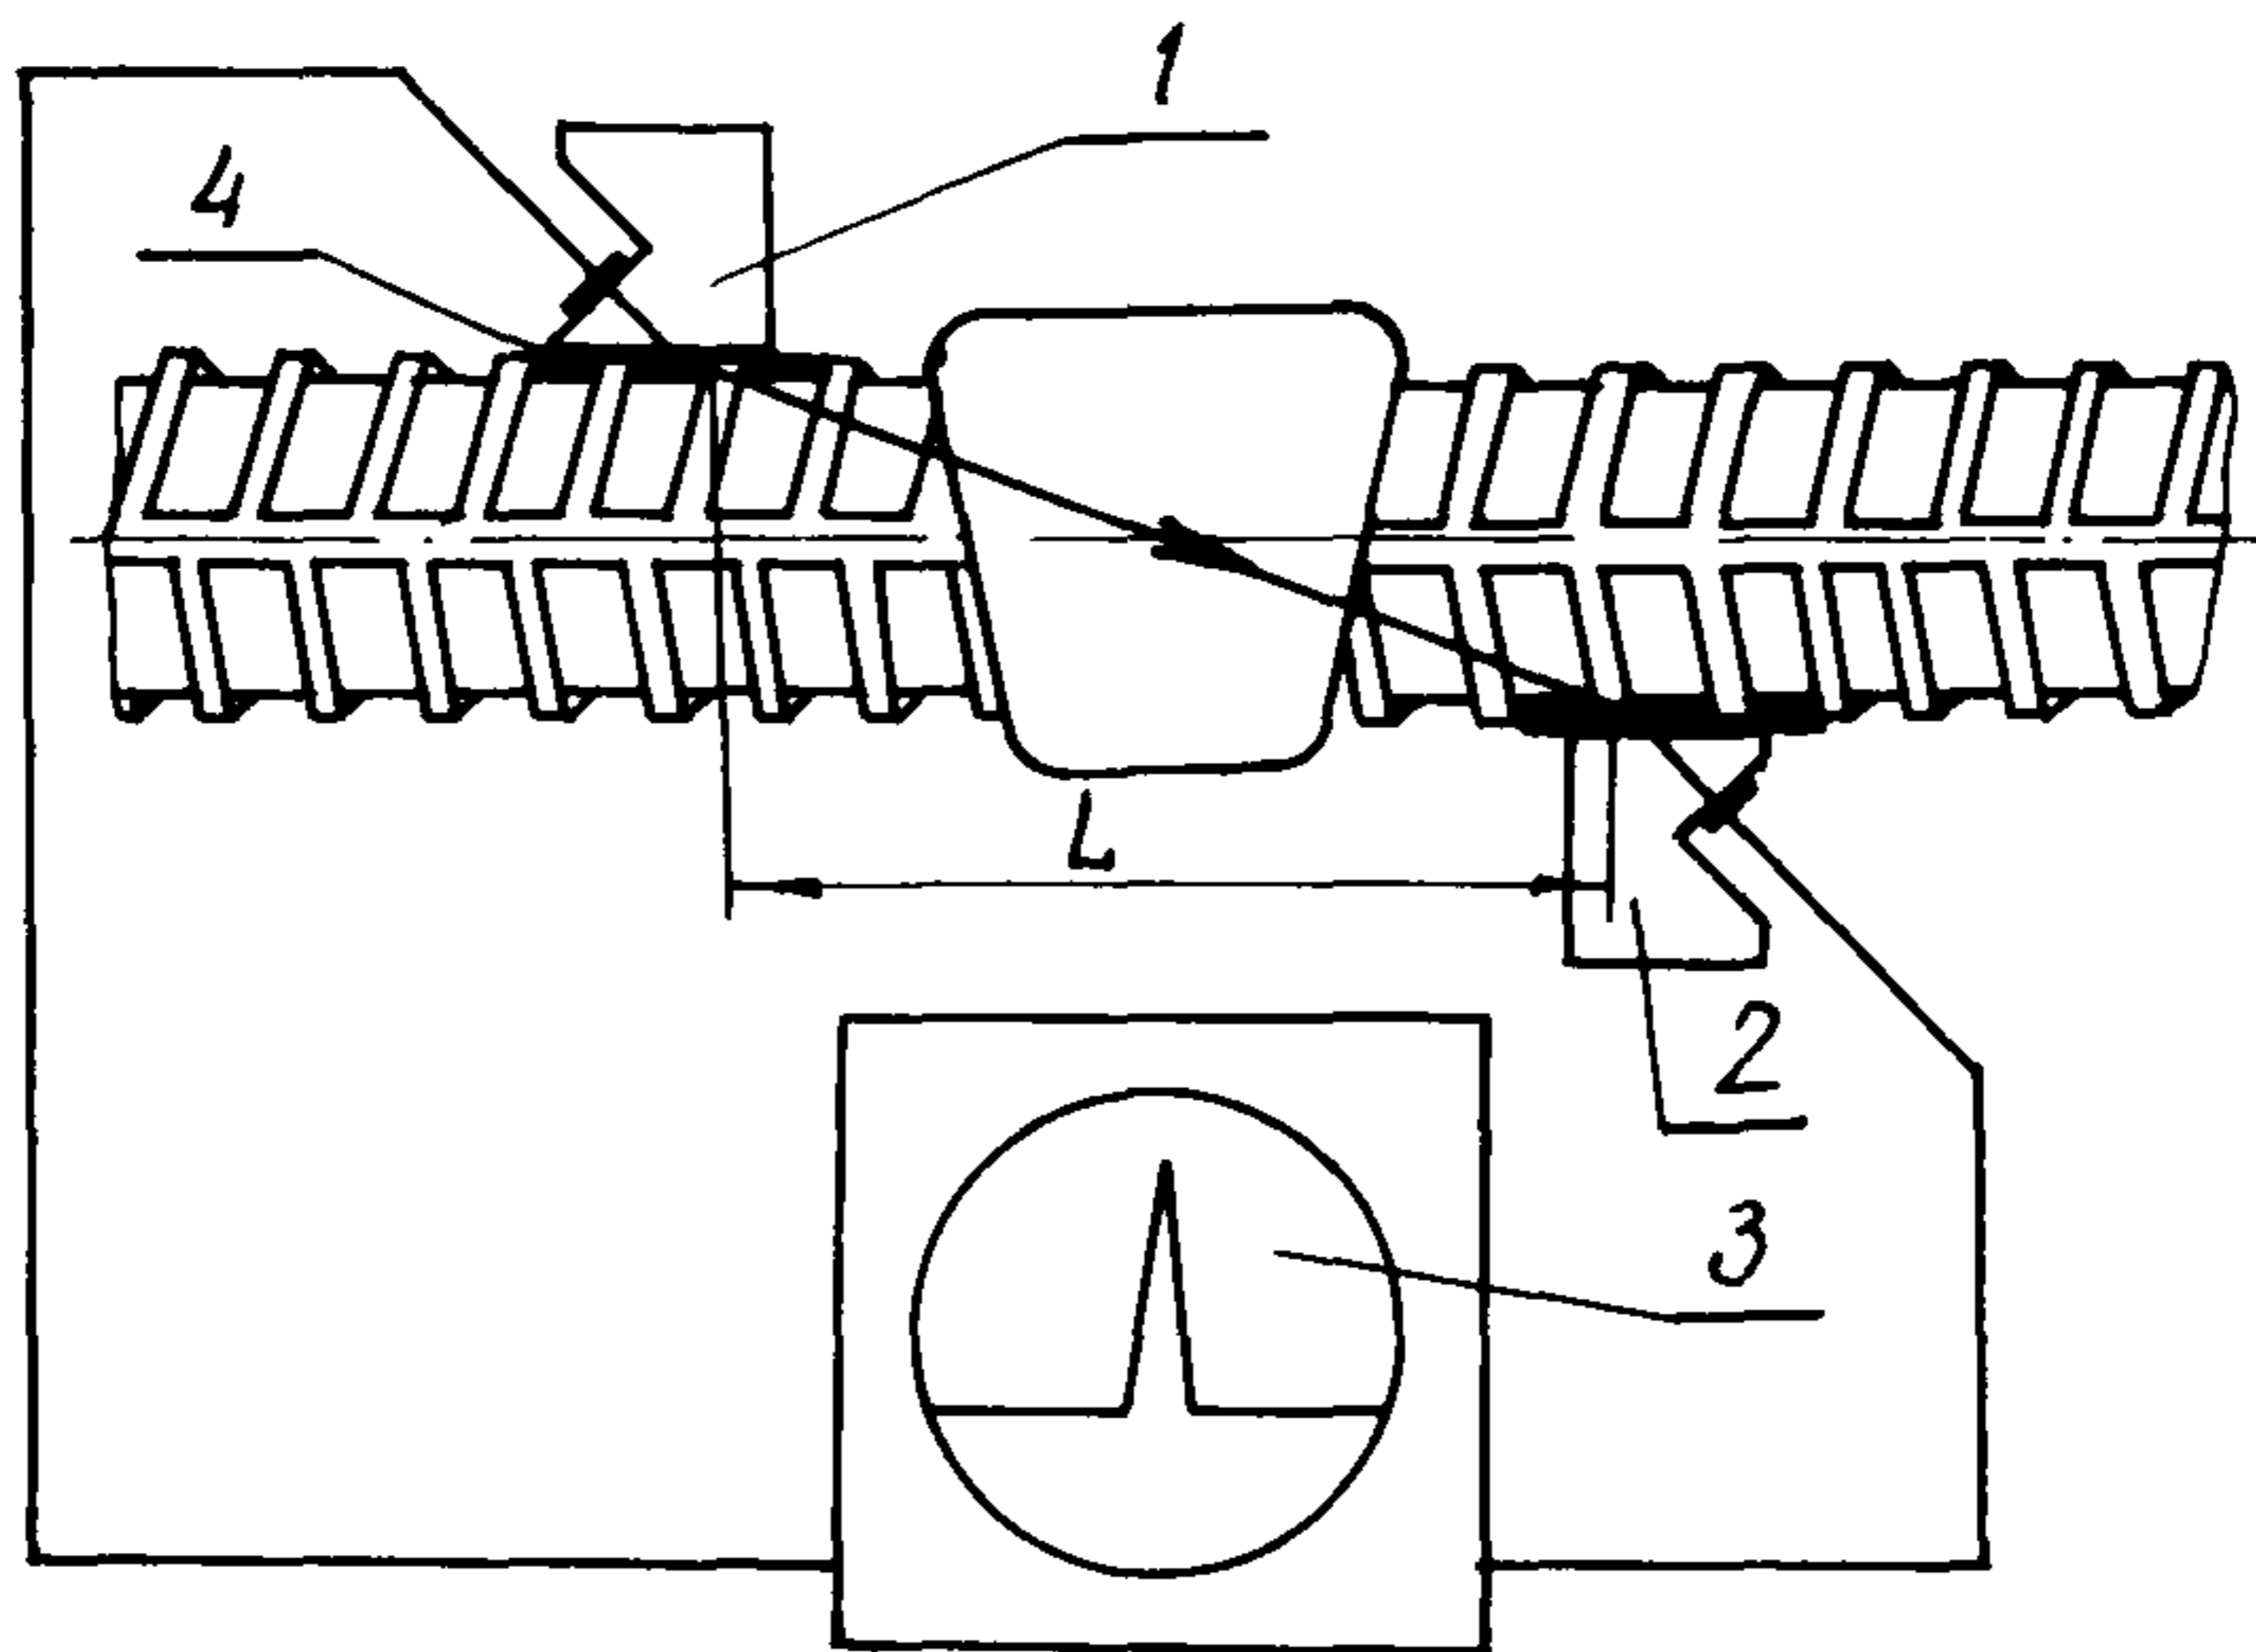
Схема ультразвукового контроля сварных стыковых соединений стержней, выполненных ванной сваркой.
